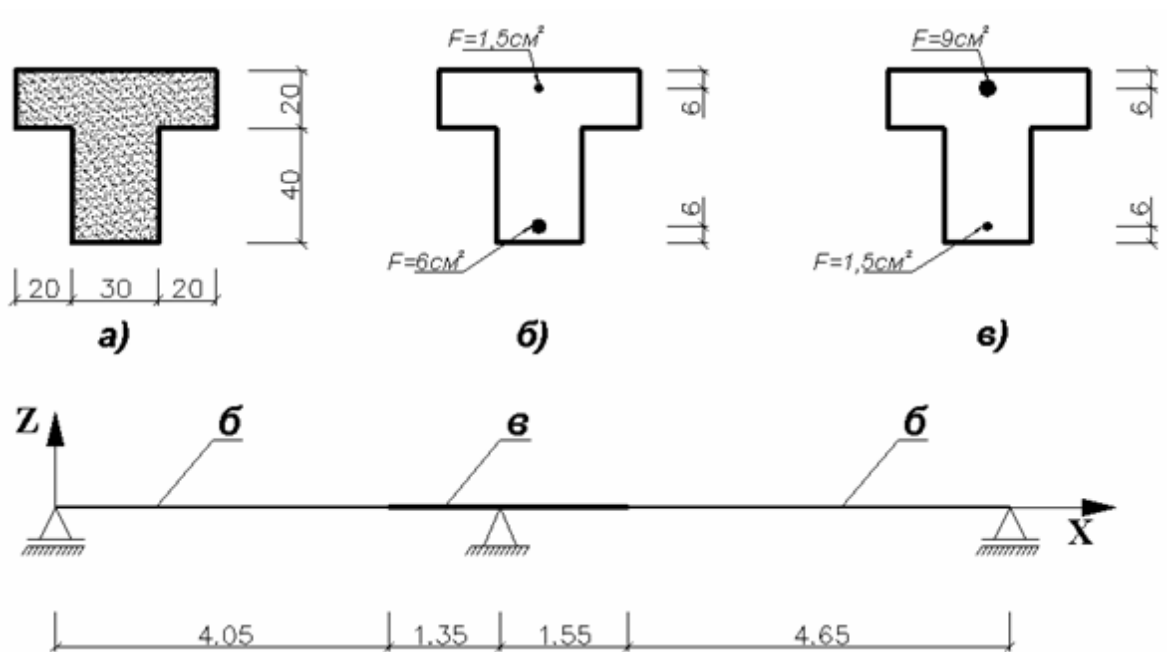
Перерізи елементів балки: а) розміри перерізу; б) прогінний переріз; в) опорний переріз
